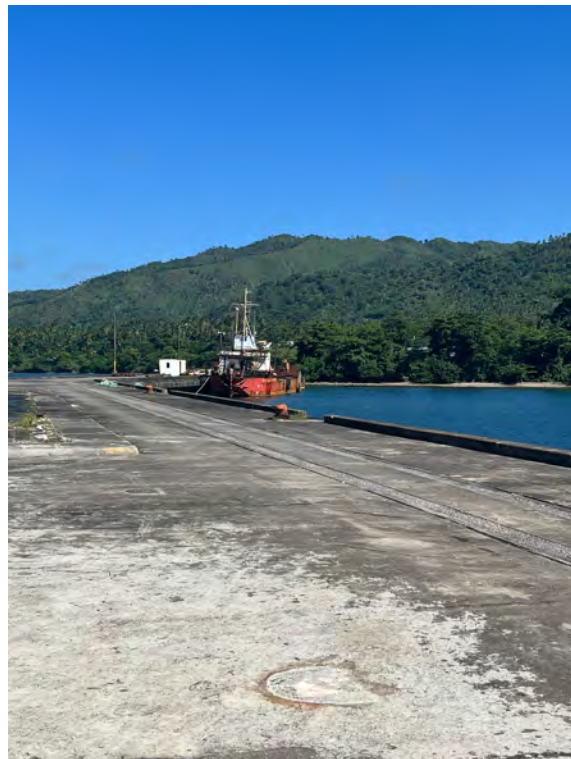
, 31, 32, 33, 34 y 35 del estado actual de las instalaciones del Puerto Duarte en Arroyo Barril.
